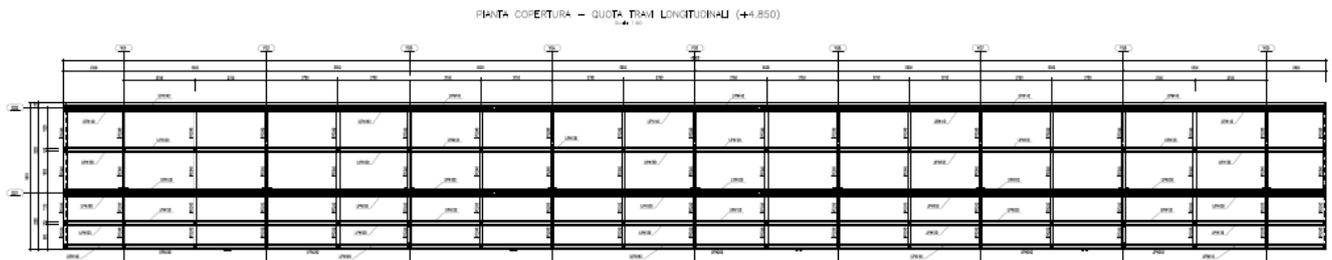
Pensiline – Pianta Copertura quota +4.850 - Pensilina Nord
